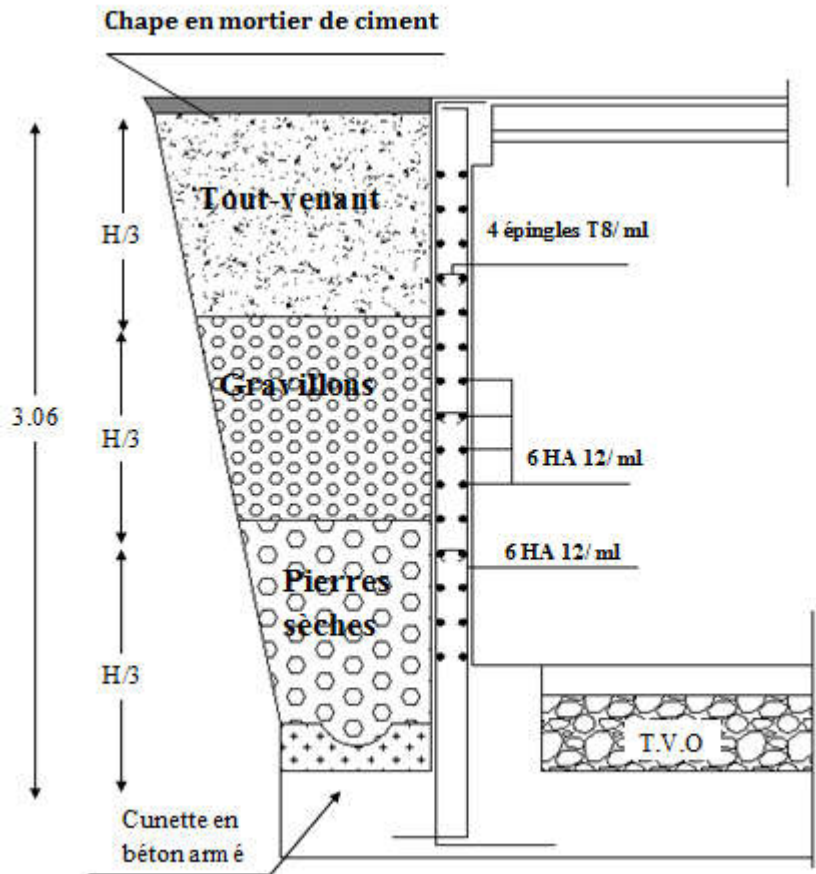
Ferrailage de voile périphérique de soutènement.
